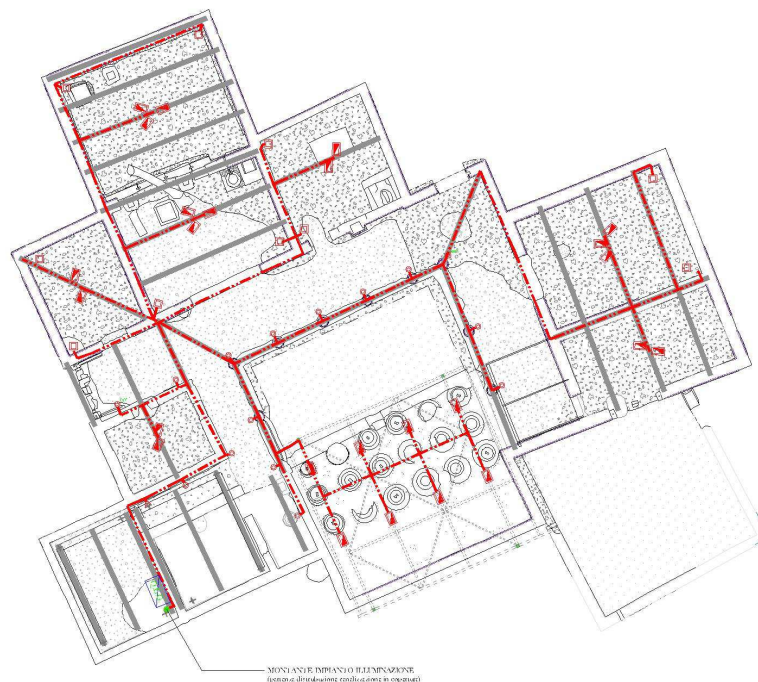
Distribuzione canalizzazioni - Pianta Piano Coperture
